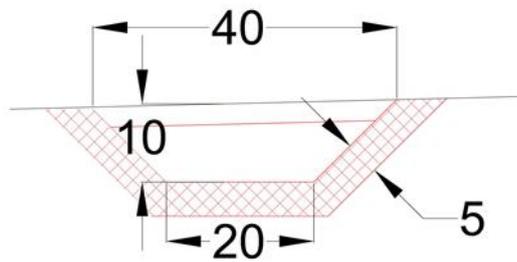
dimensioni della canaletta prefabbricata di forma trapezia
